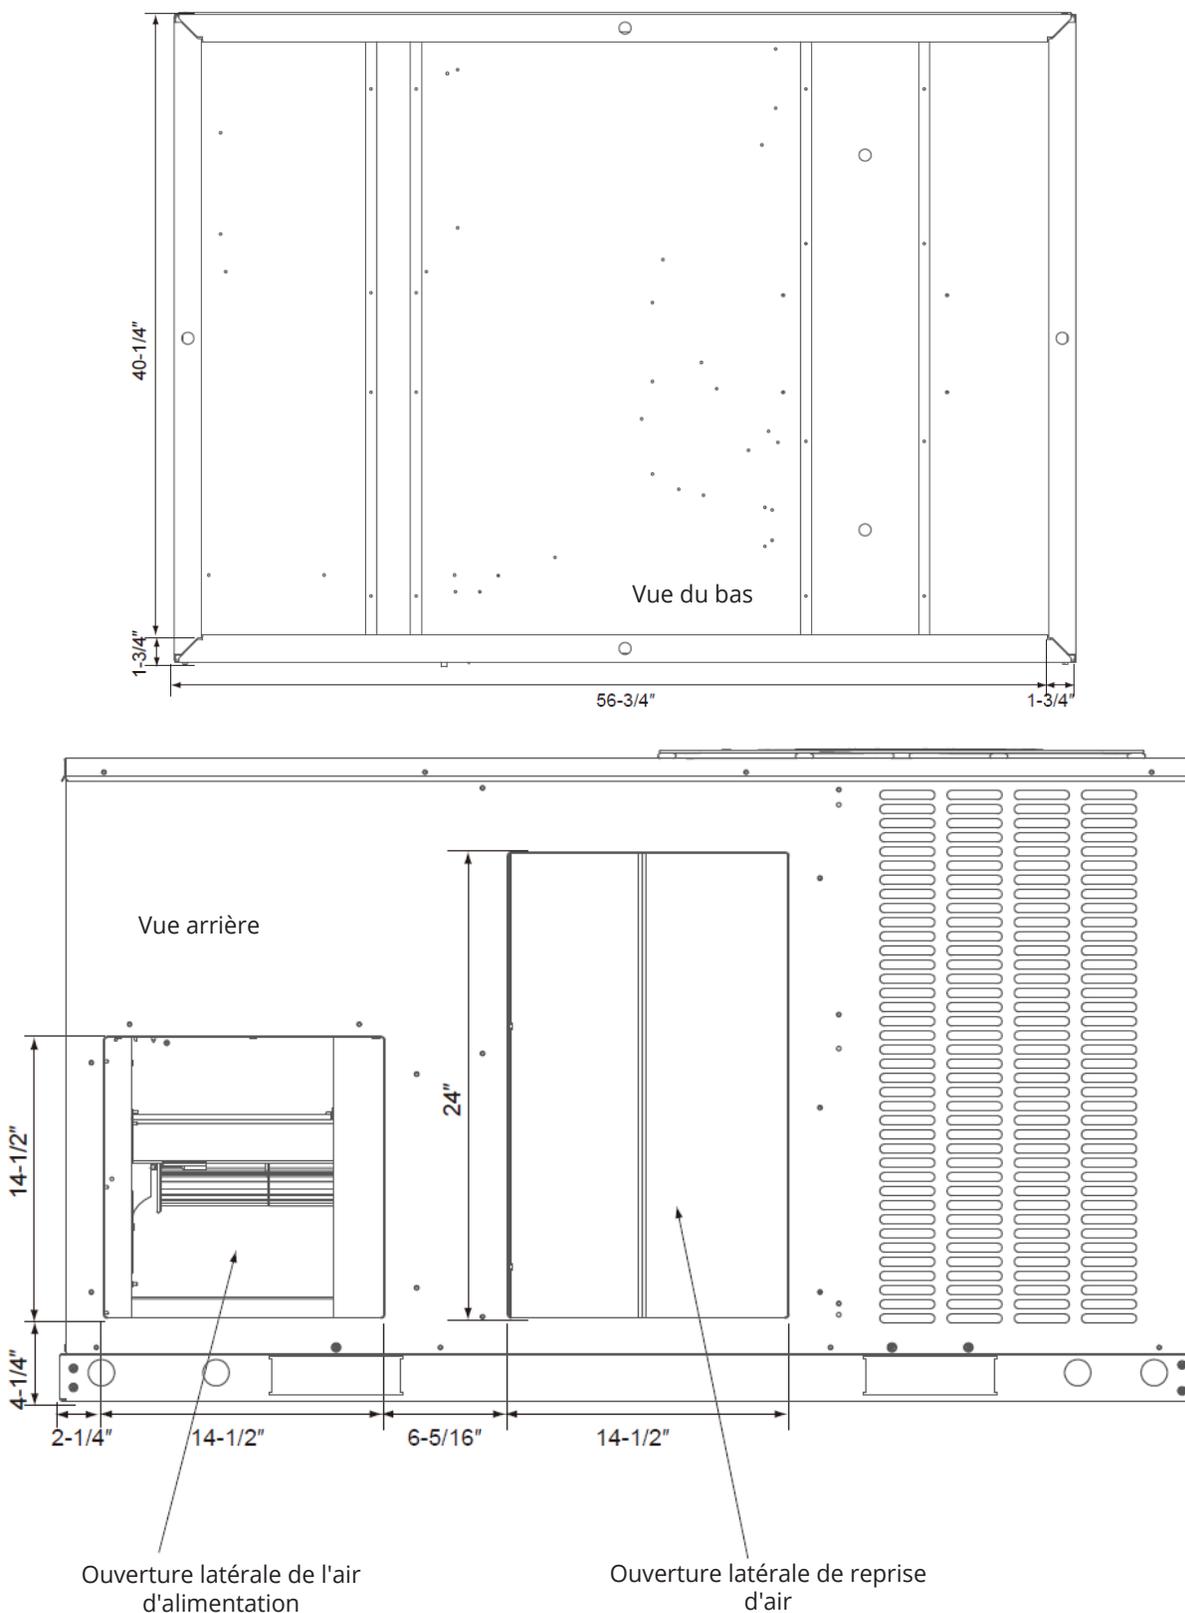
Dimensions arrière et du bas des unités : 42k, 48k, et 60k
